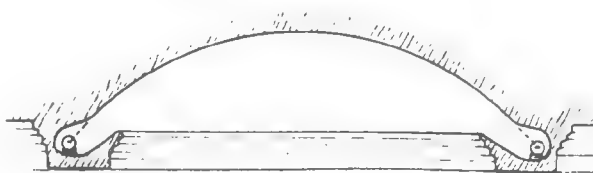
Detalle constructivo de la iluminación que muestra la Fig. N° 1
